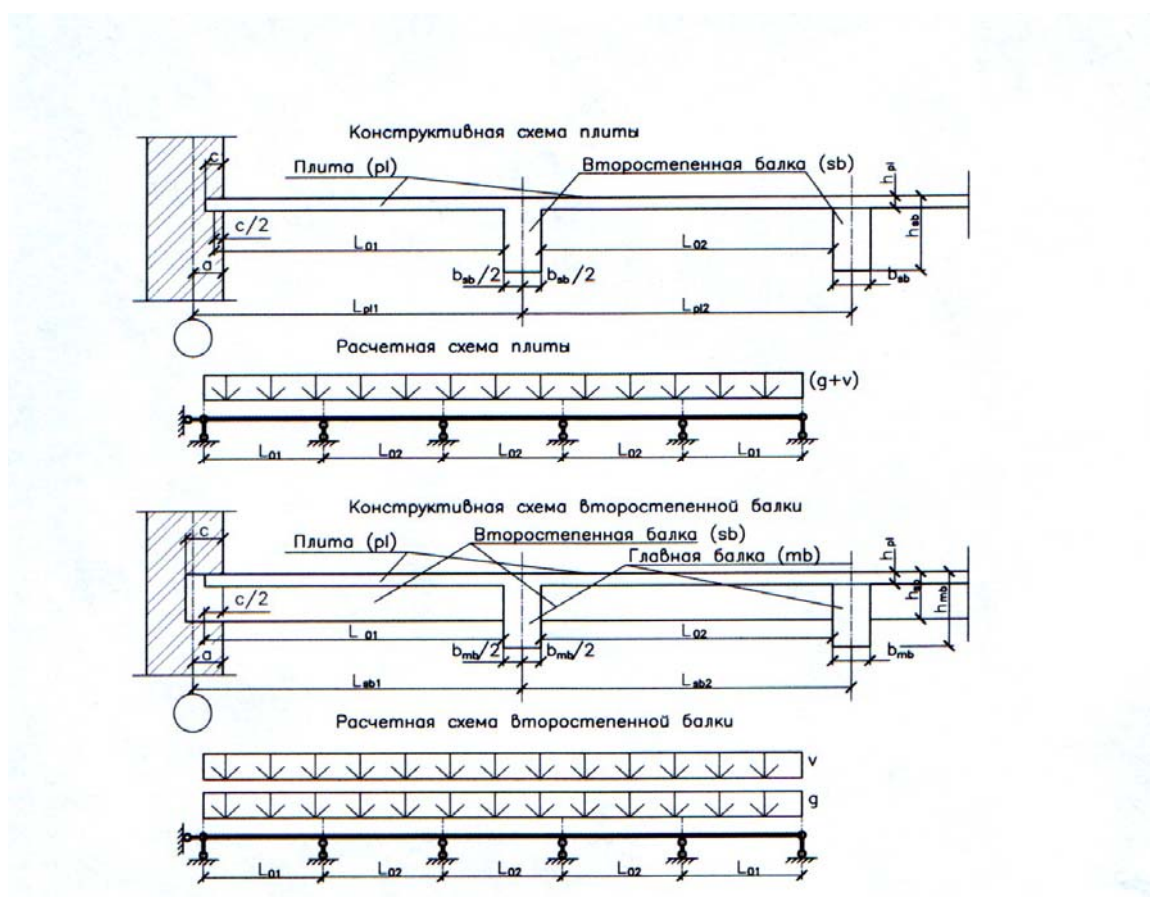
К построению расчетных схем элементов монолитного перекрытия
